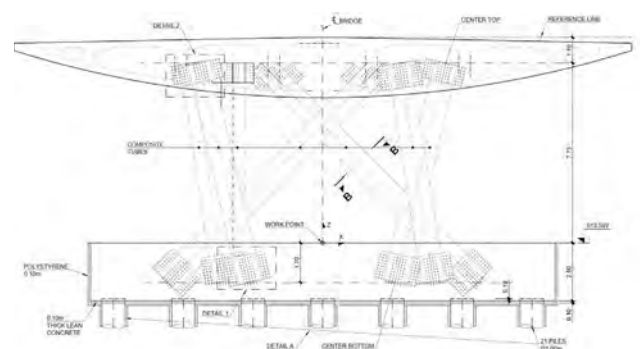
Sección transversal sobre pilas; cada pila está formada por siete tubos mixtos inclinados.
